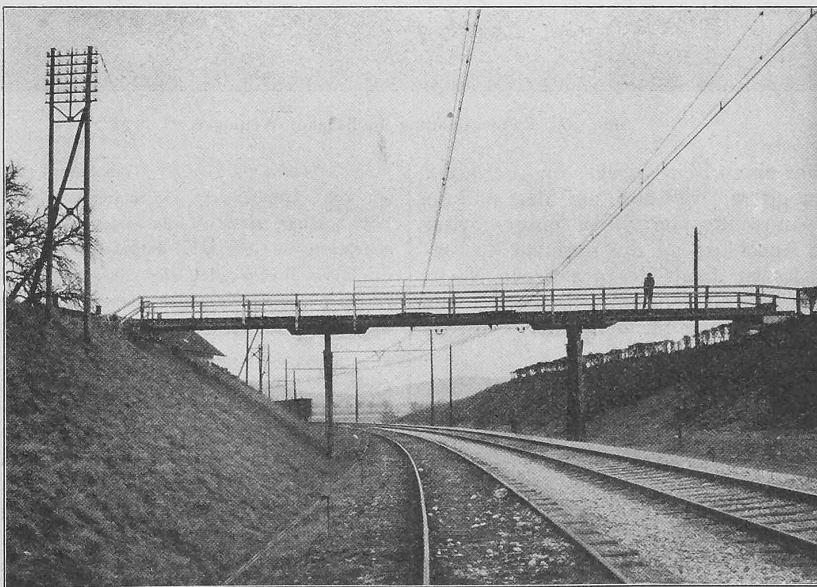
Unterführung einer hölzernen Wegbrücke bei Wettingen.
